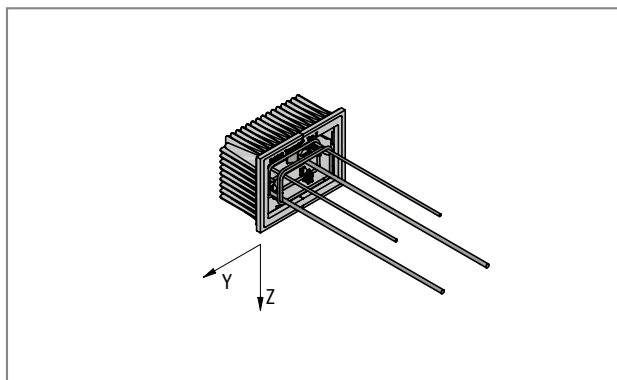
Schöck Tronsole® typ Z: Půdorys betonové konzoly se zabudovaným armokošem
